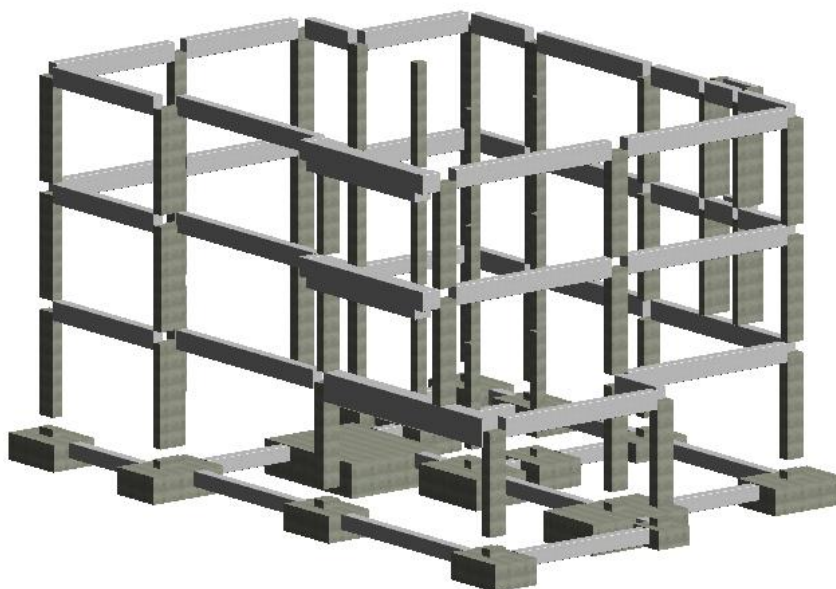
Elementos de Fundações, Pilares e Vigas do Modelo Virtual.
